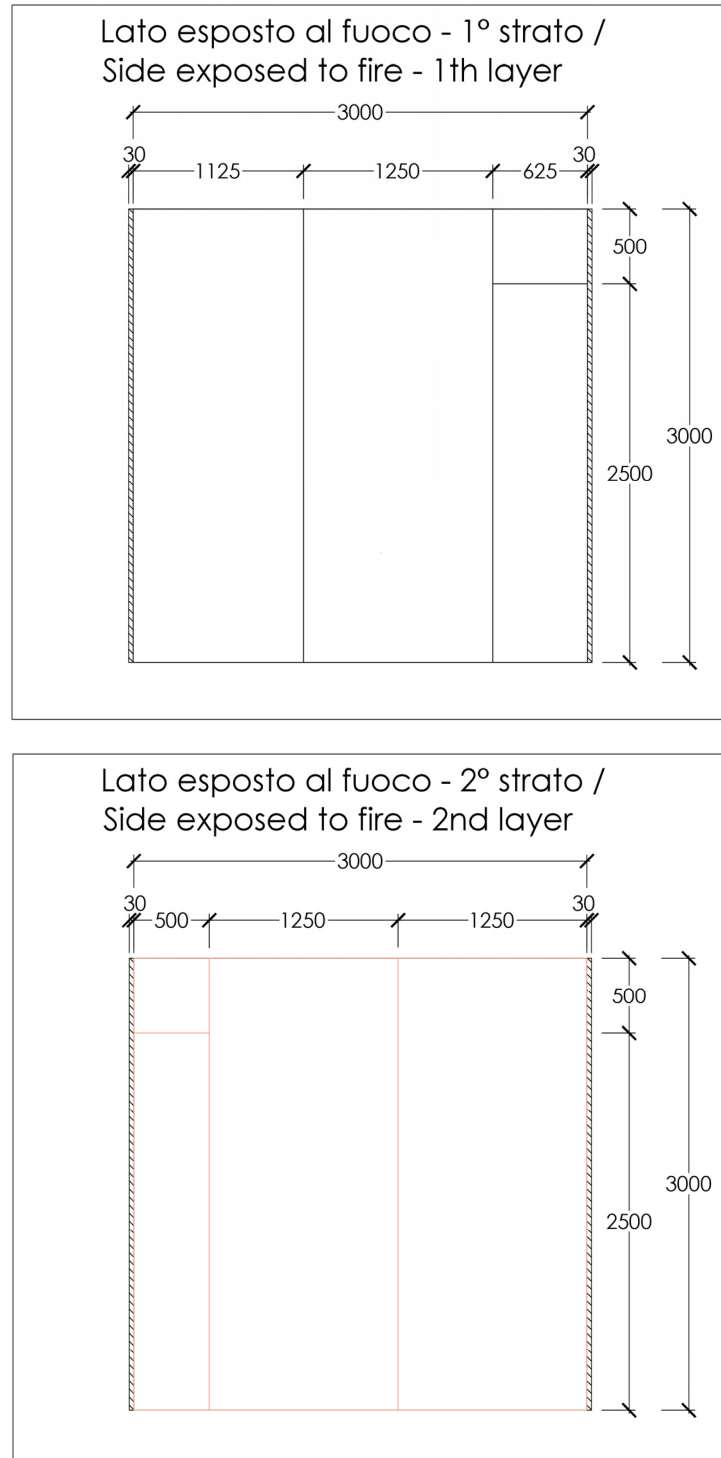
Disposizione lastre – lato esposto / Plasterboards layout – exposed side
